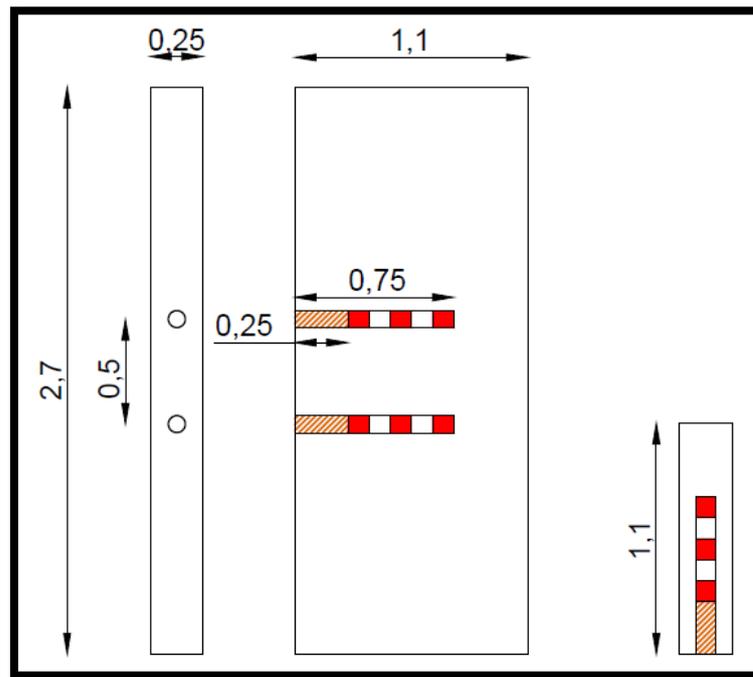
Alzado, perfil y planta del pilar "Refuerzo 1".
